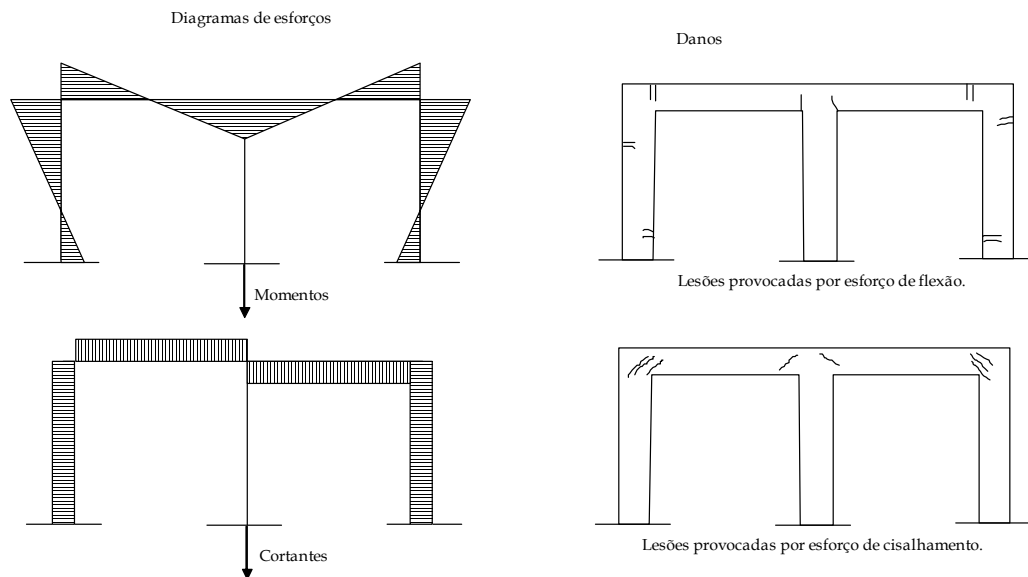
Prováveis diagramas de esforços e fissuras em estruturas de concreto por recalques de fundações de pilares internos (Recalque Central) (adaptado de MAÑÁ, 1978 *apud* MILITITSKY et al., 2005).
